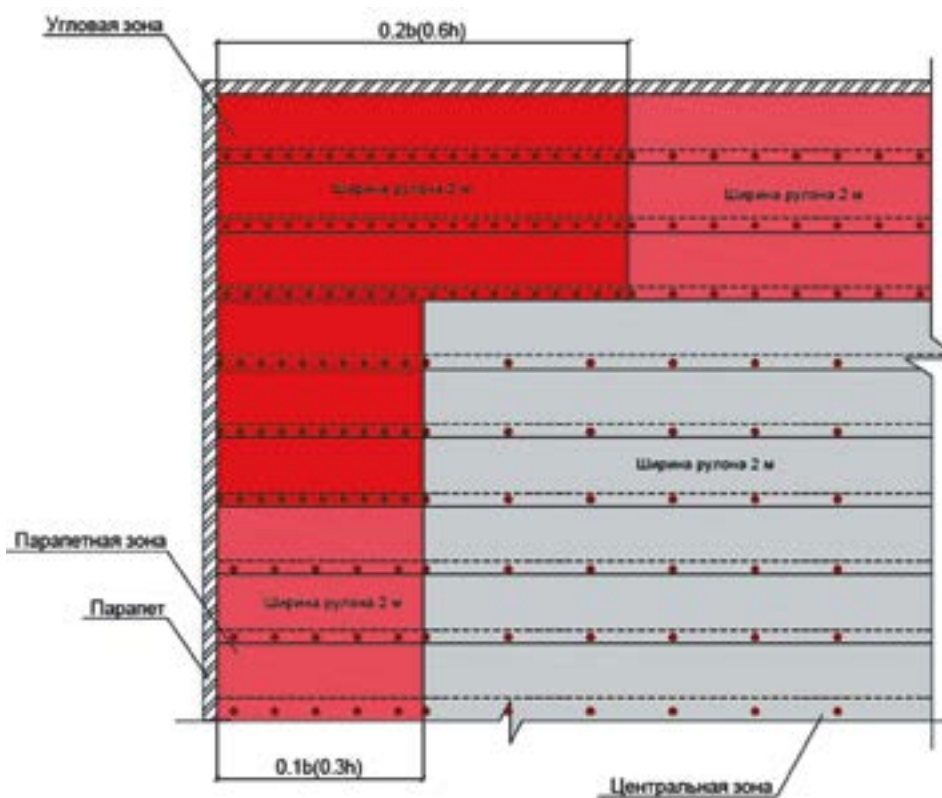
Вариант раскладки и крепления полотен полимерной мембраны к бетонному основанию или цементно-песчаной стяжке
